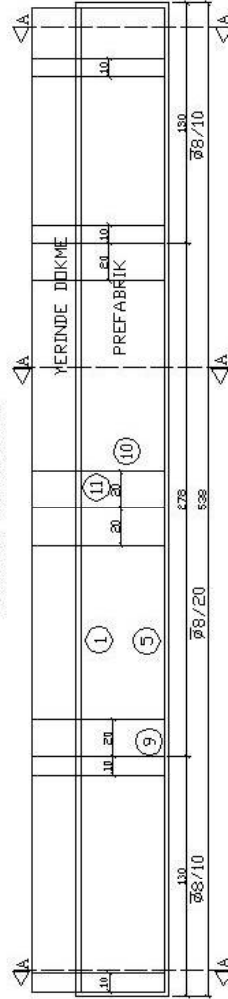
Prefabrike sanayi yapısı DK1 kirişi detayı
